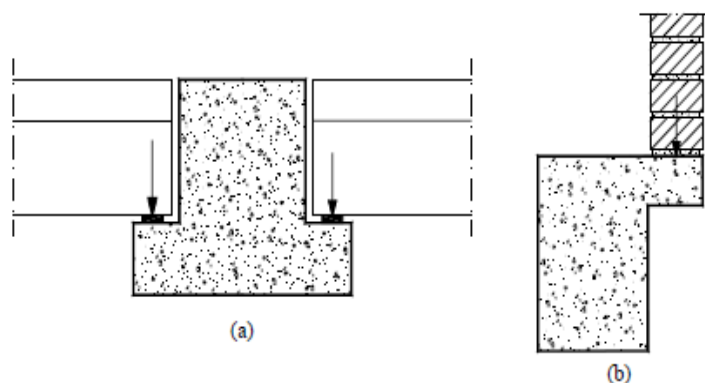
Vigas do tipo: (a) “T”. (b) “L”. [7]
